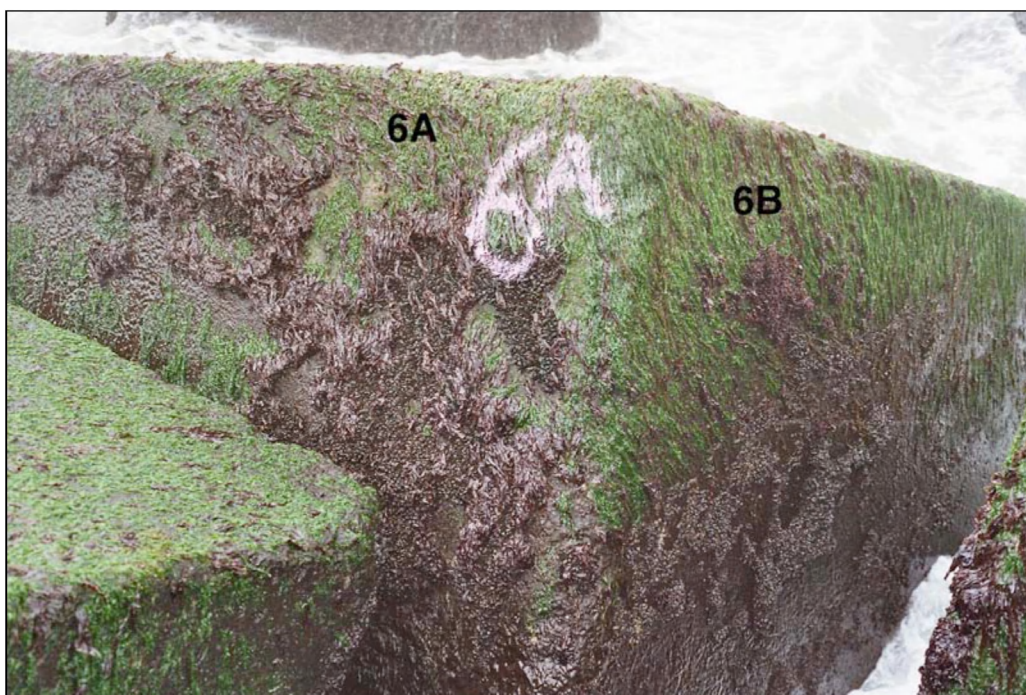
#011. Blok 6, vlak 2 (A op foto) en 4 (B op foto).
